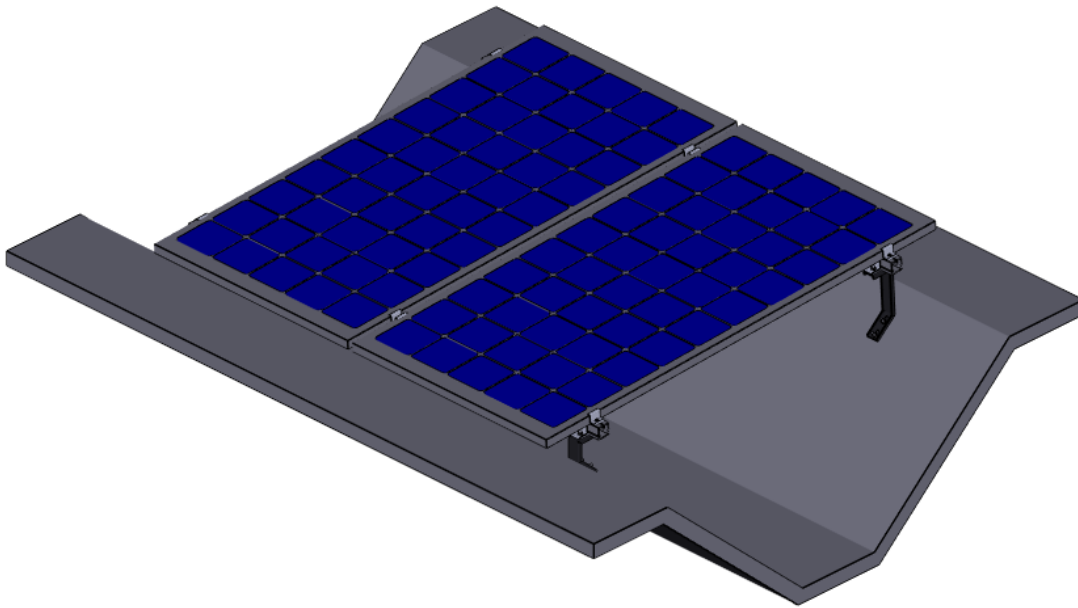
Demonstração de instalação dos módulos fotovoltaicos em telhado de concreto protendido em W.
